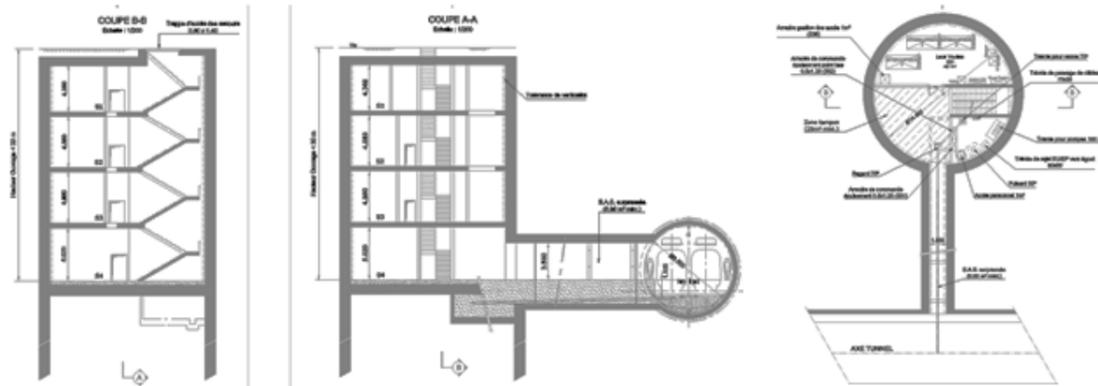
Coupe et vue en plan niveau cheminement OA accès secours et d'épuisement circulaires
